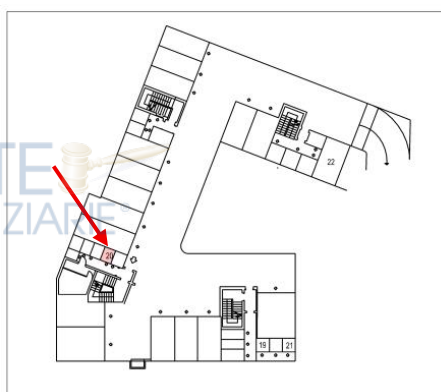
Individuazione della collocazione della cantina del subalterno 20 sulla planimetria del piano interrato
